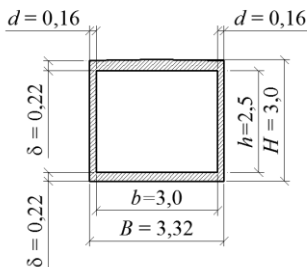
Поперечное сечение типового звена водопропускной трубы ЗП 16.100-F
